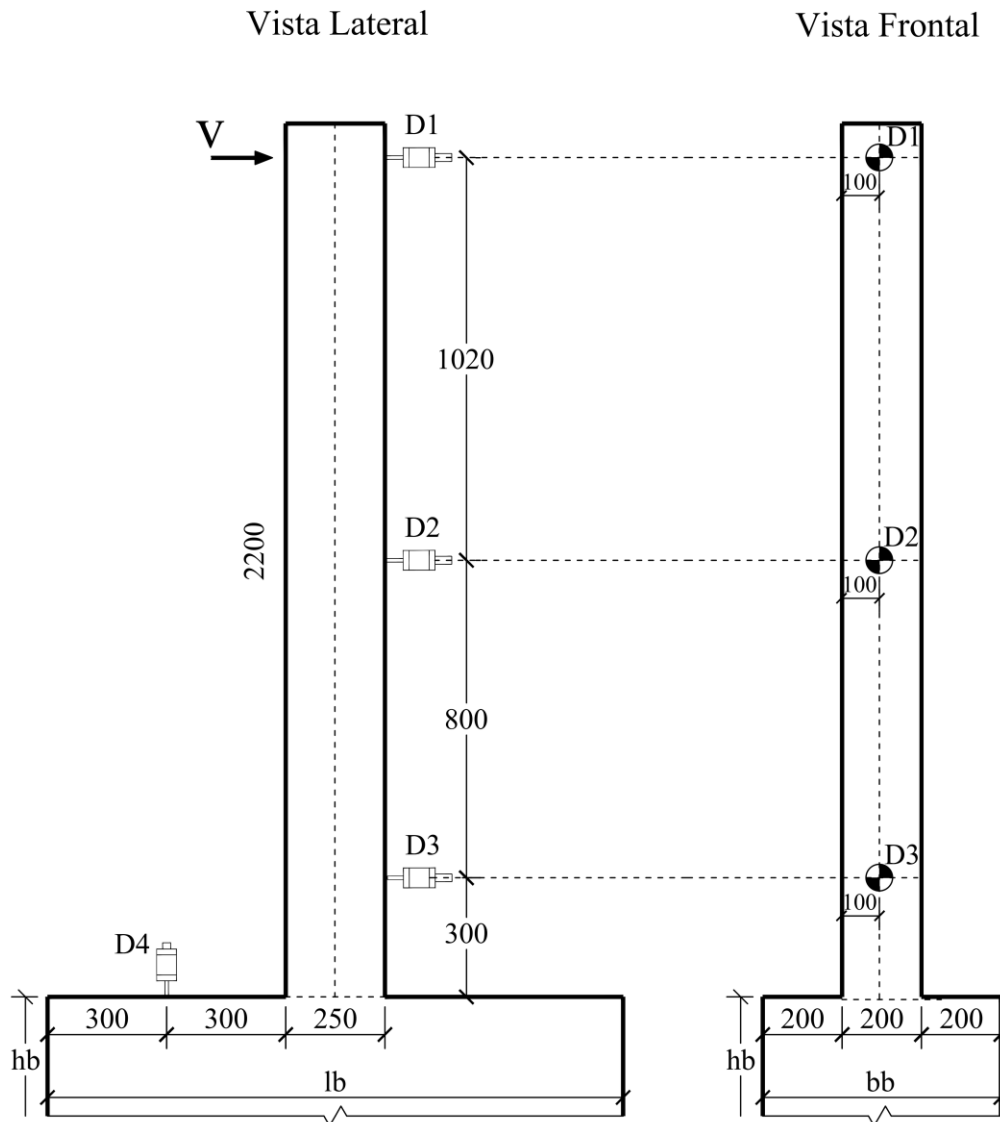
Posição dos potenciômetros nos pilares P1/P2 e P5/P6 (Fonte: Autor)
